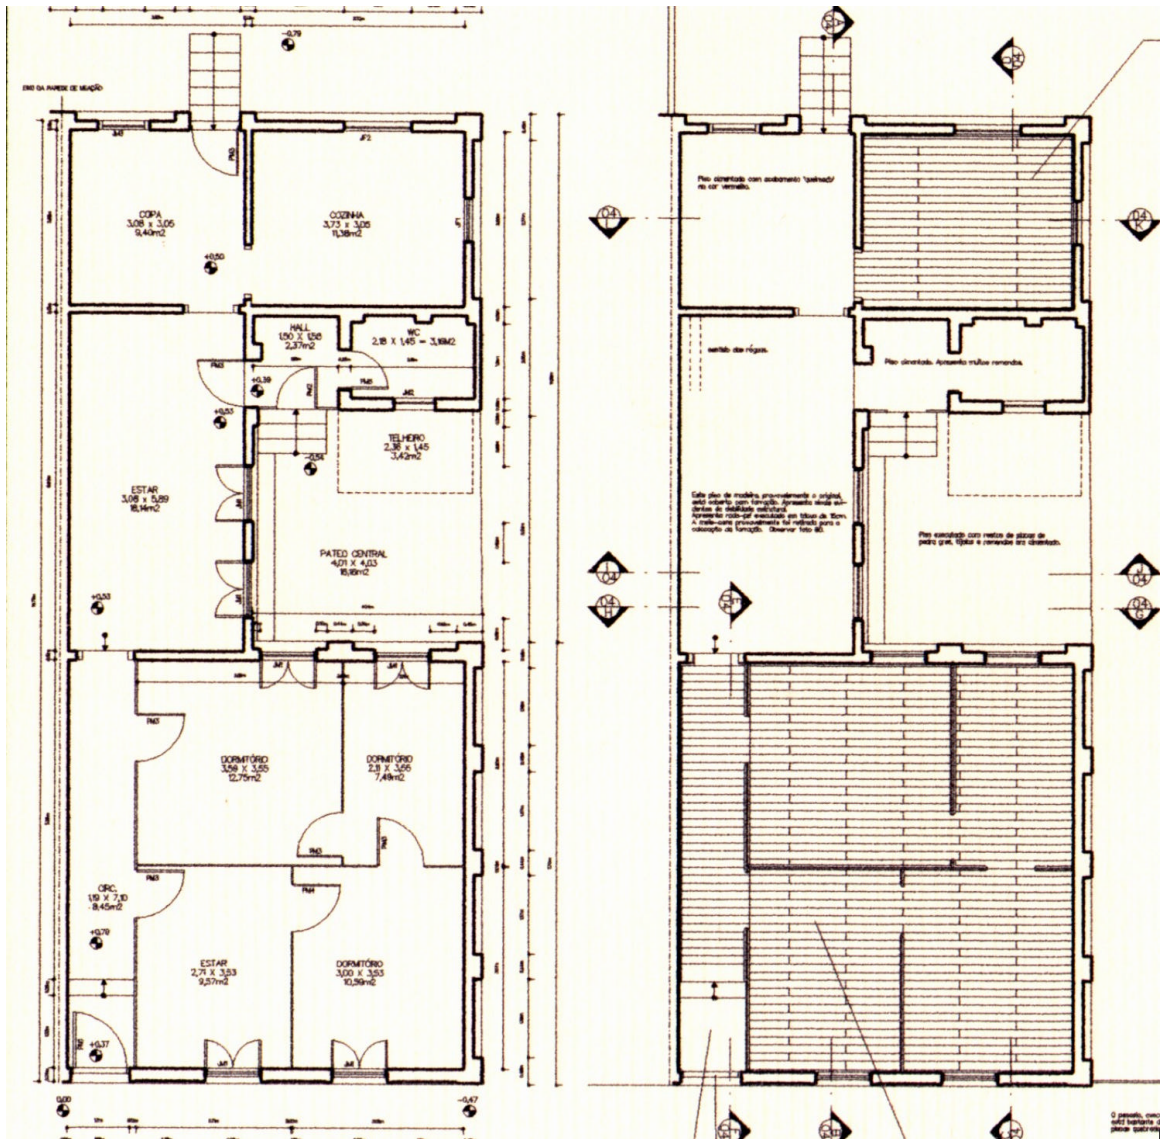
Plantas baixa e paginação de pisos conforme levantamento efetuado.
